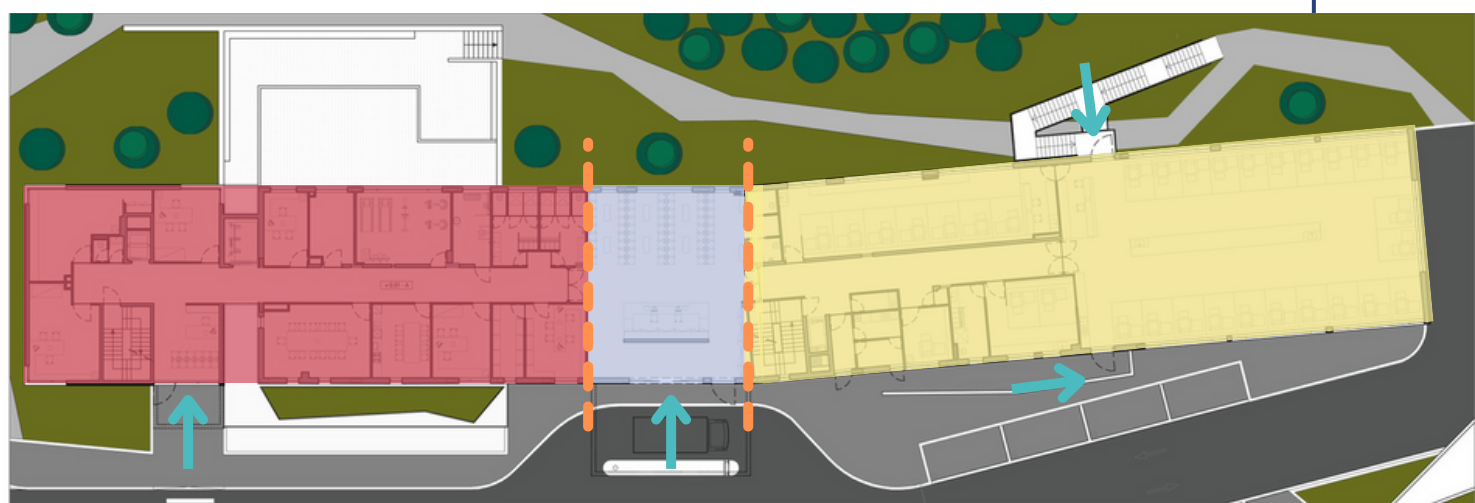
| Planta Térreo - Nordial Center [Fonte: Archdaily]
